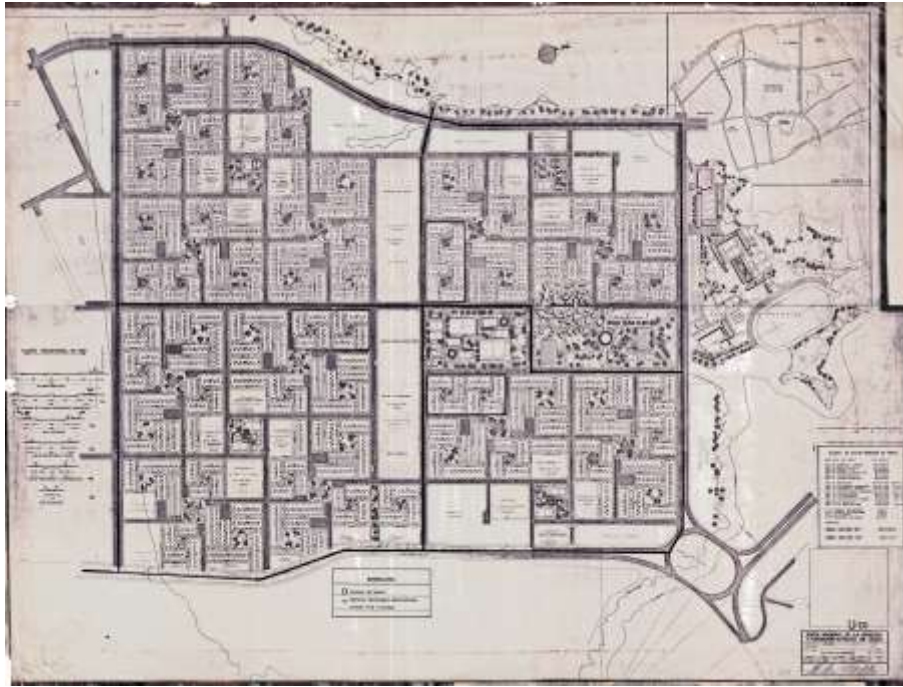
Trazado Urbano De La Propuesta De Vivienda Solanda.
